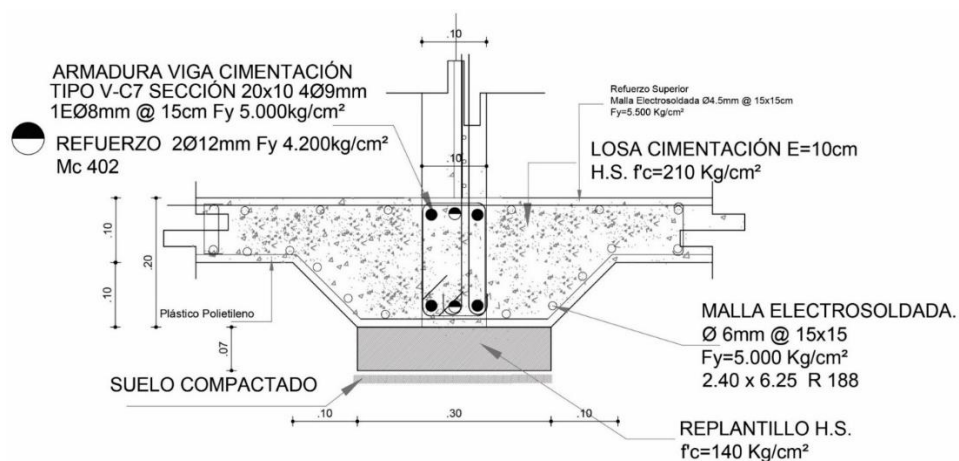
Viga de Cimentación en parte central de la losa. (Duque, 2016).
